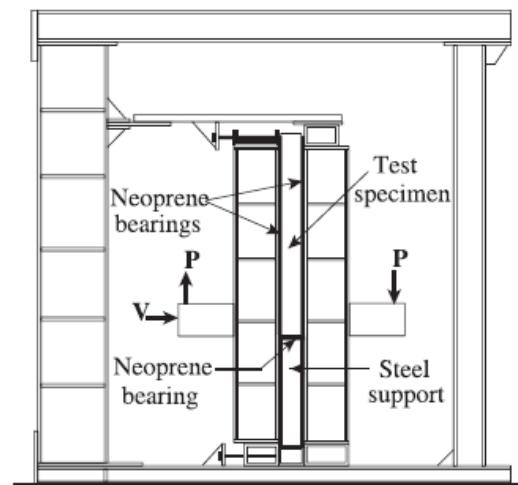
Apoyos de la estructura. (Ghali & Megally, 2000)
